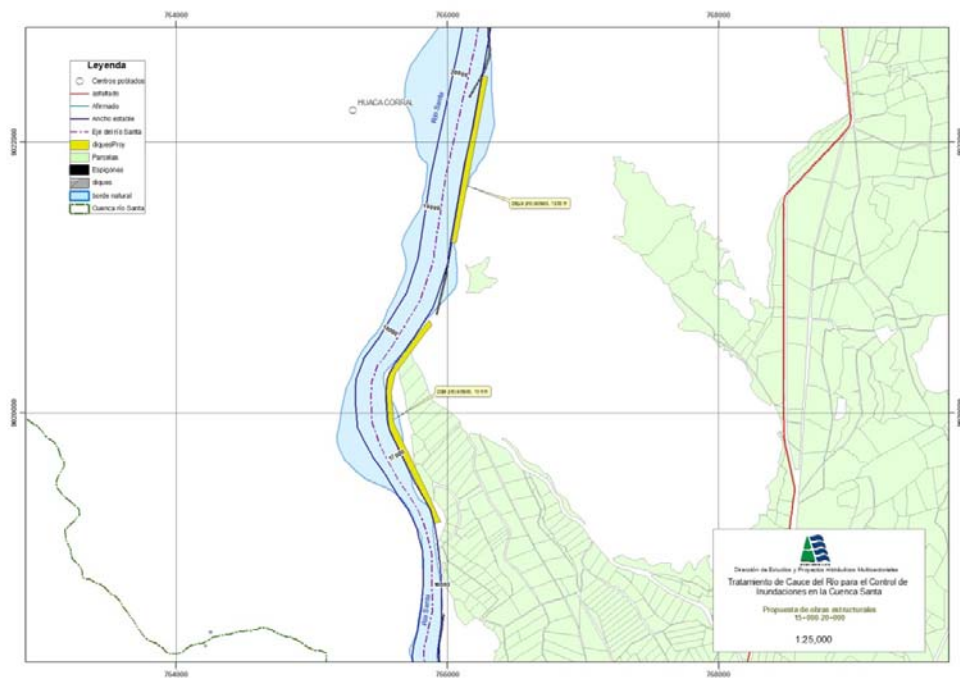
Estructuras proyectadas en el tramo 15-20+000
